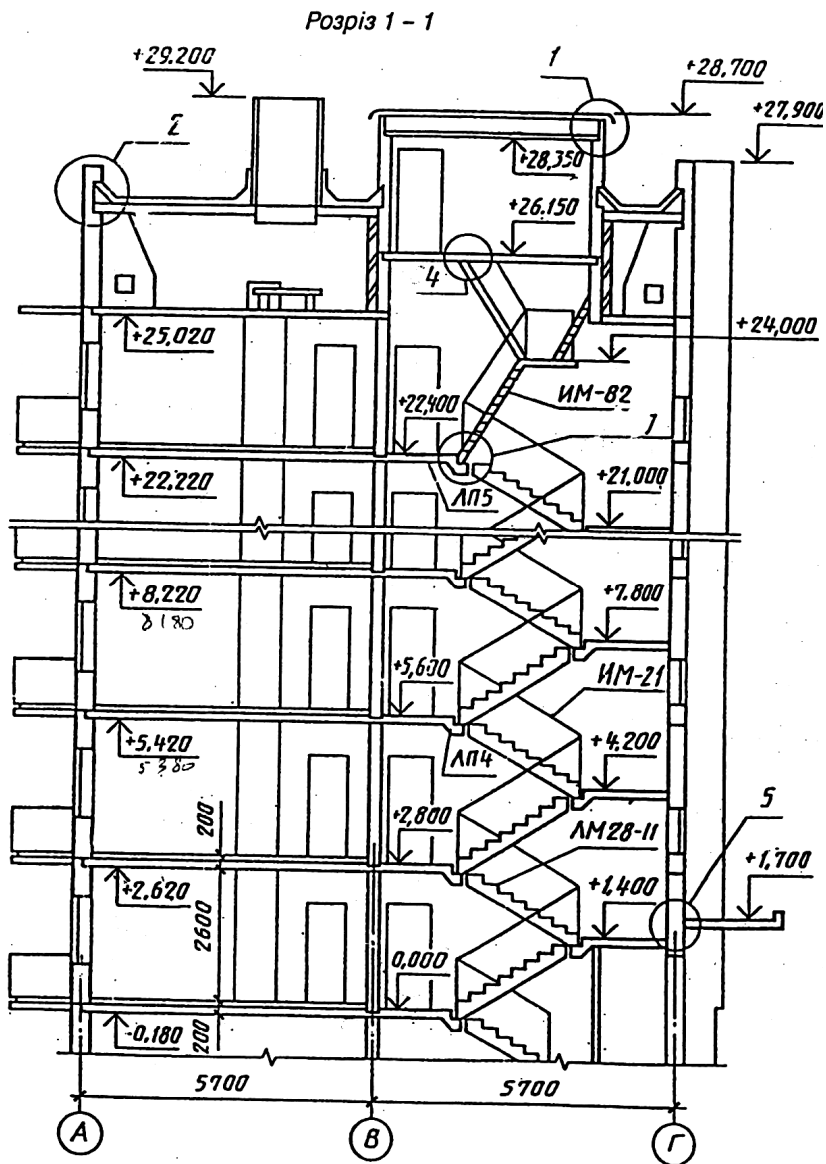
Стандартне виконання креслення поперечного розрізу багатоповірхової великопанельної житлової будівлі
